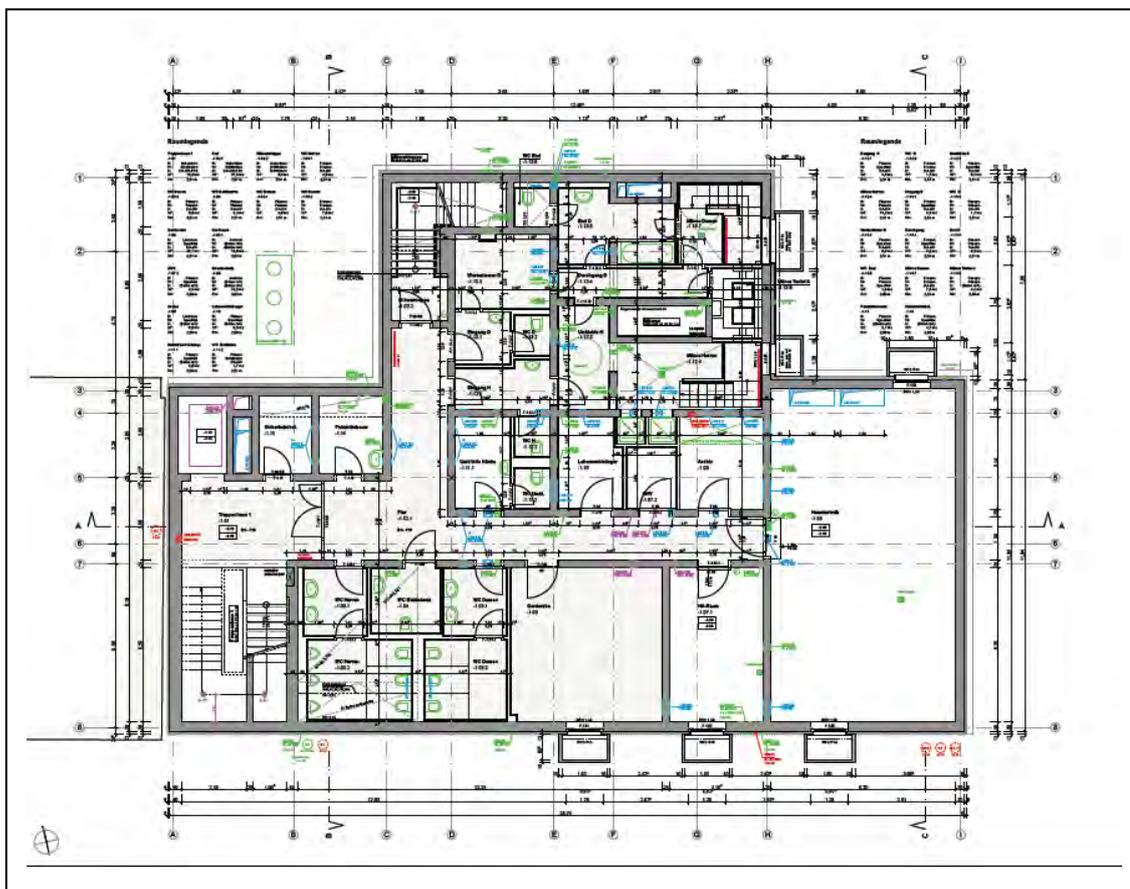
Grundriss 1. UG Ursprungentwurf,
